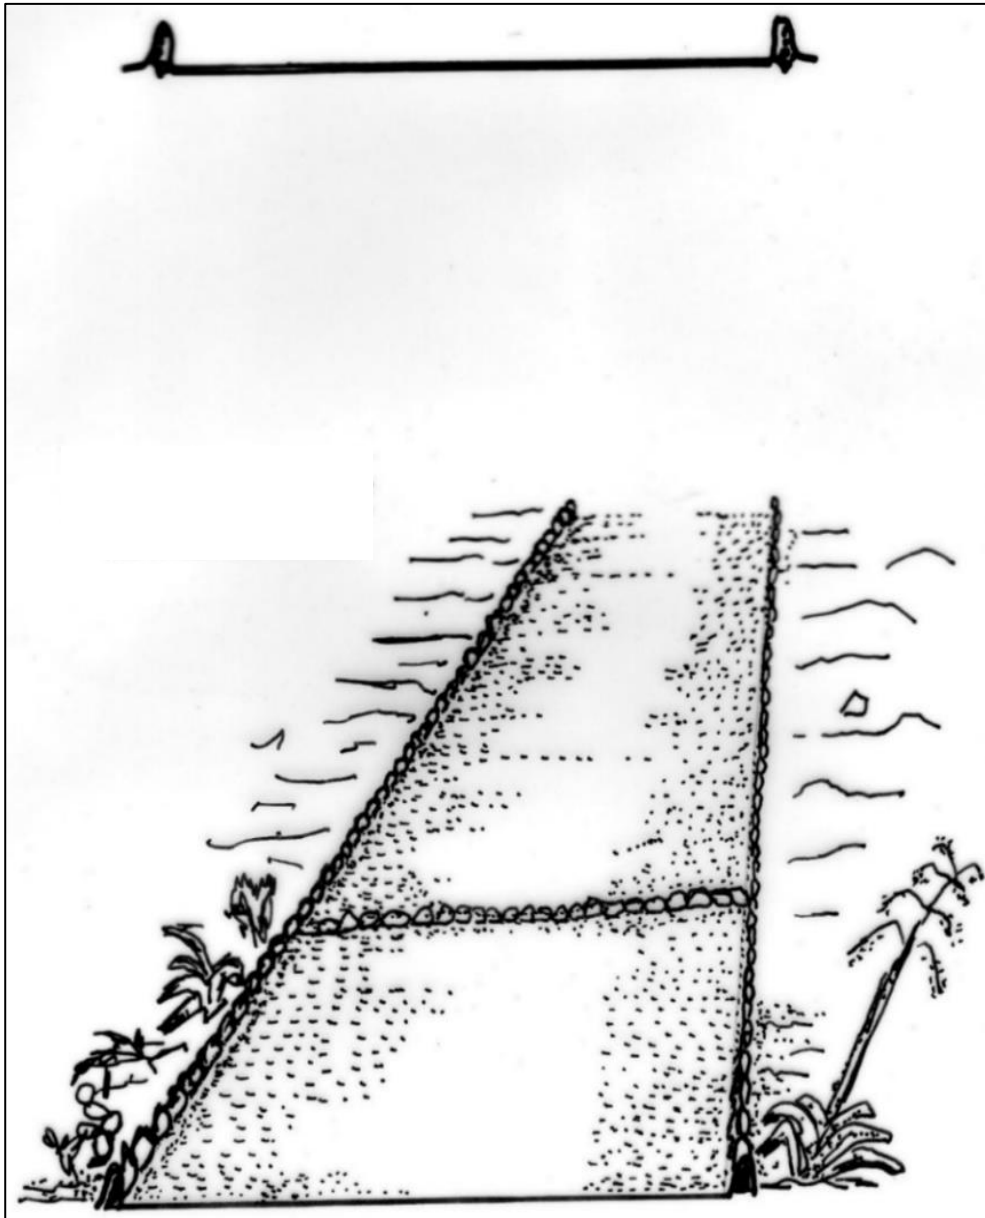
Croquis de planta y corte del camino Wari en Tablapampa.
